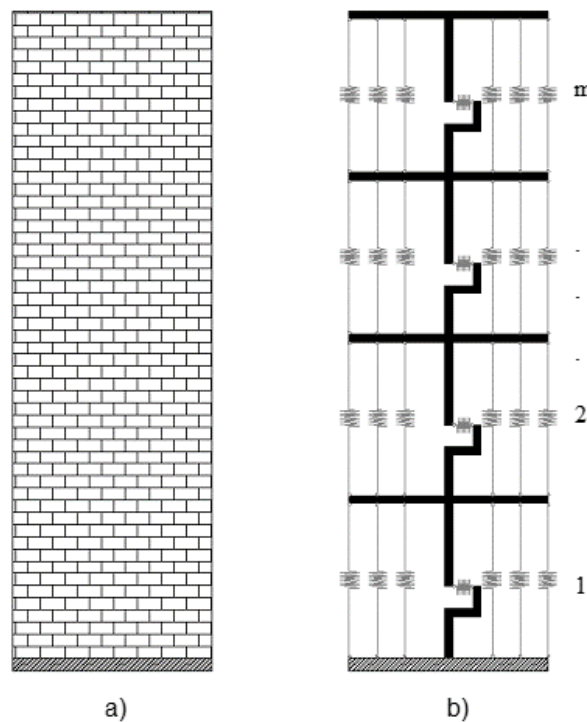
a) Muro de mampostería b) Modelo del muro usando MVLEM
